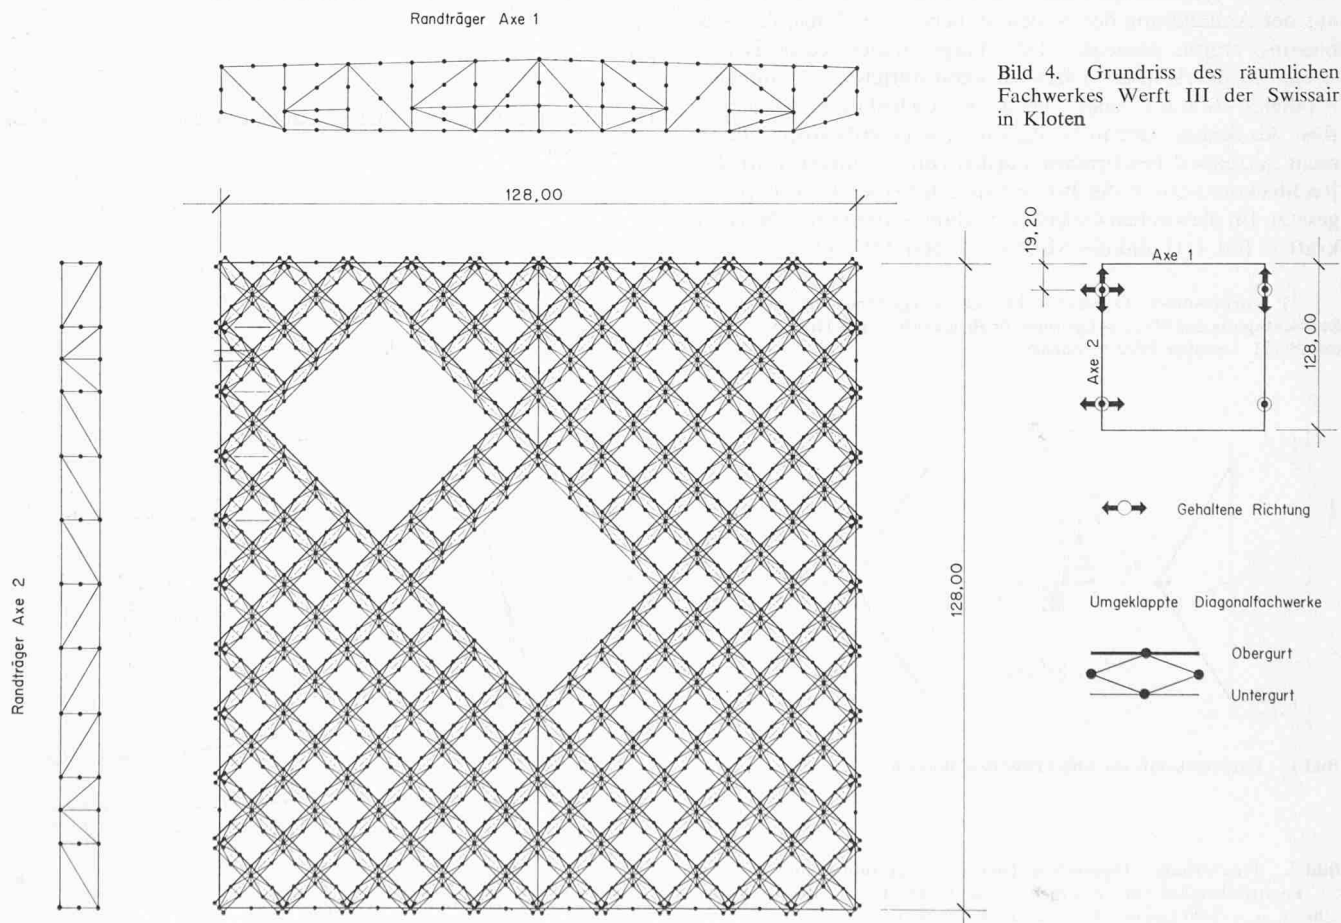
Grundriss des räumlichen Fachwerkes Werft III der Swissair in Kloten
